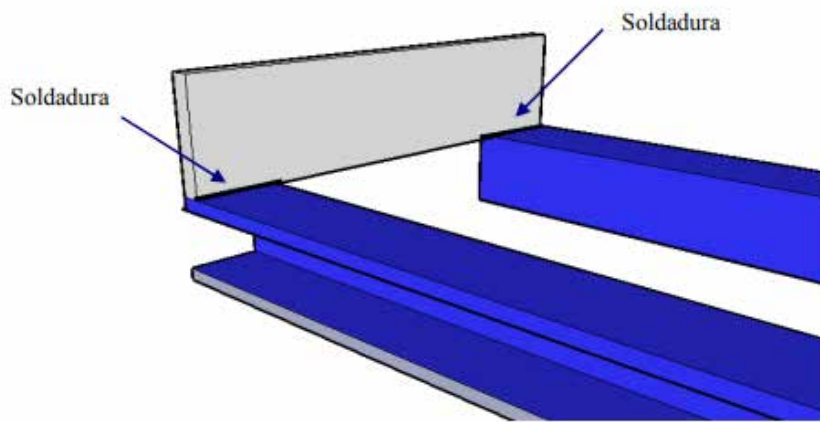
Soldadura entre la lámina y el perfil.
